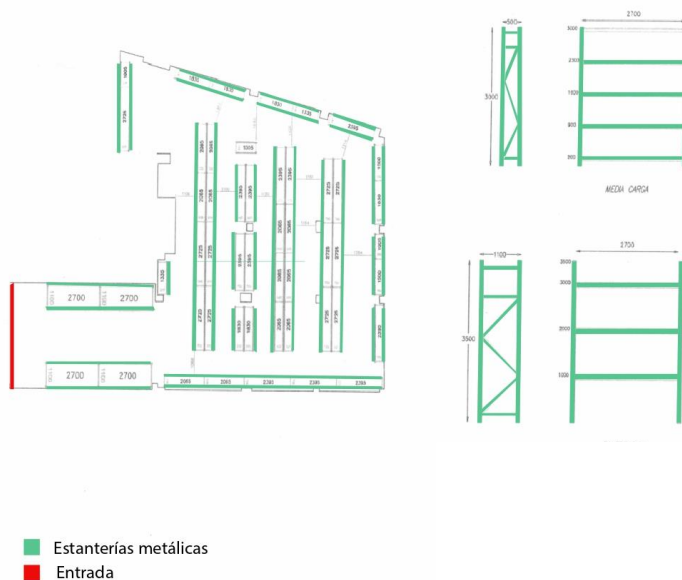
Plano con la vista general de la planta baja en la calle San Jacinto en Paterna destacando en verde las estanterías metálicas.
